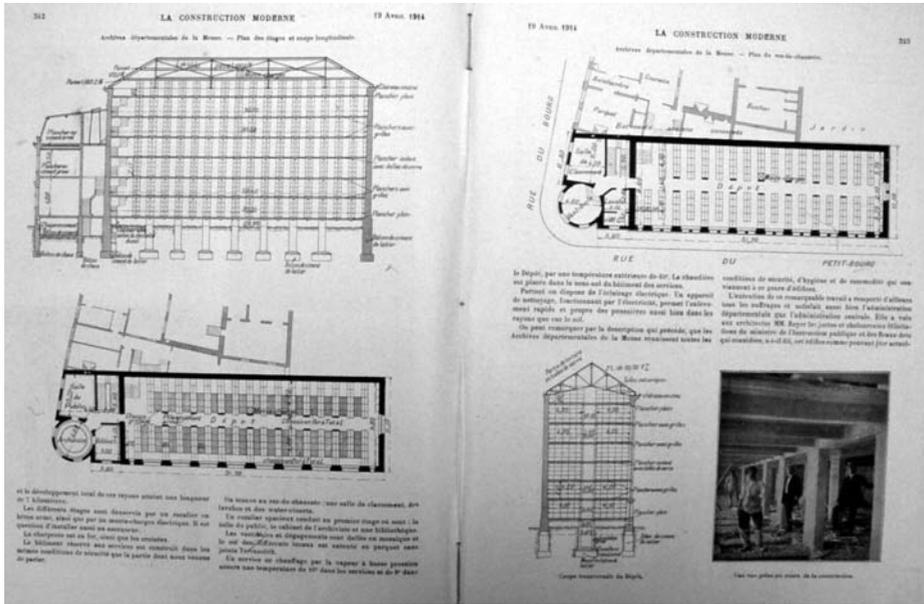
Plans et coupe des archives départementales de la Meuse («La Construction moderne», 19 avril 1914, pp. 342-343).
